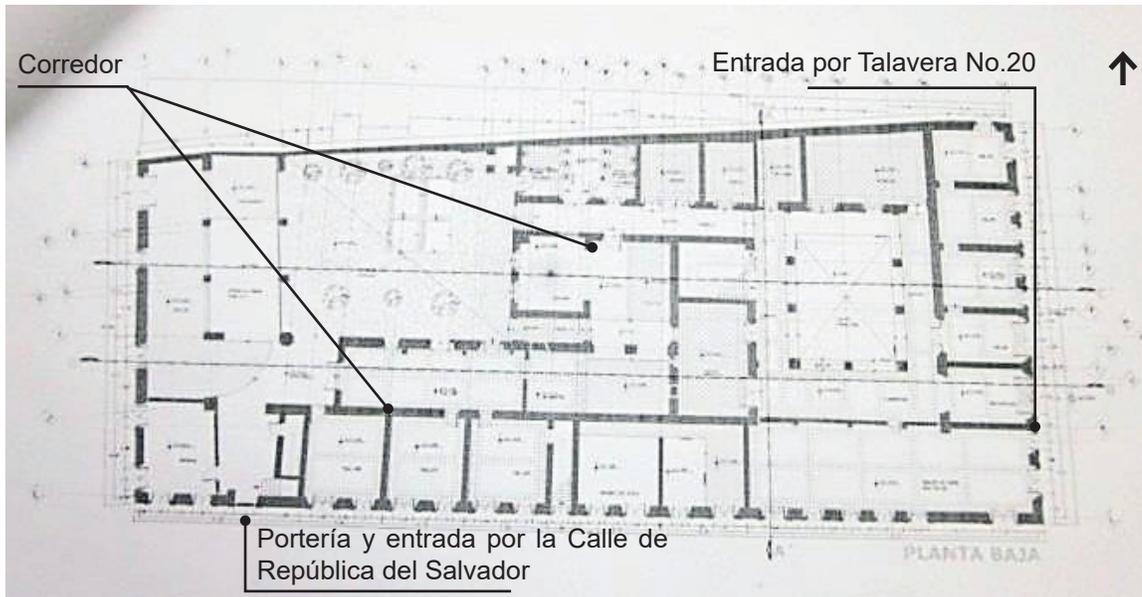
Planta baja del edificio de la Casa Talavera donde se marcan los cambios hechos al lugar para darle mantenimiento como escuela en 1912. Fuente: planta baja arquitectónica (UACM, 2010).
